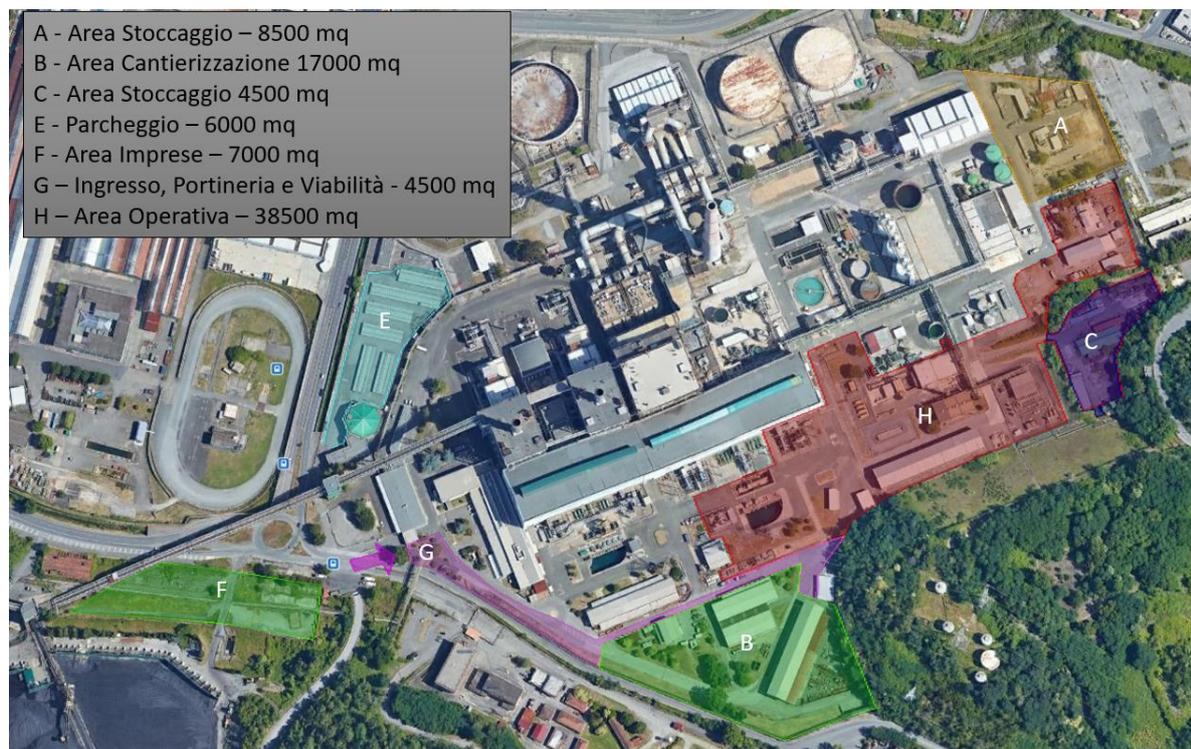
Rappresentazione delle aree di cantiere previste
